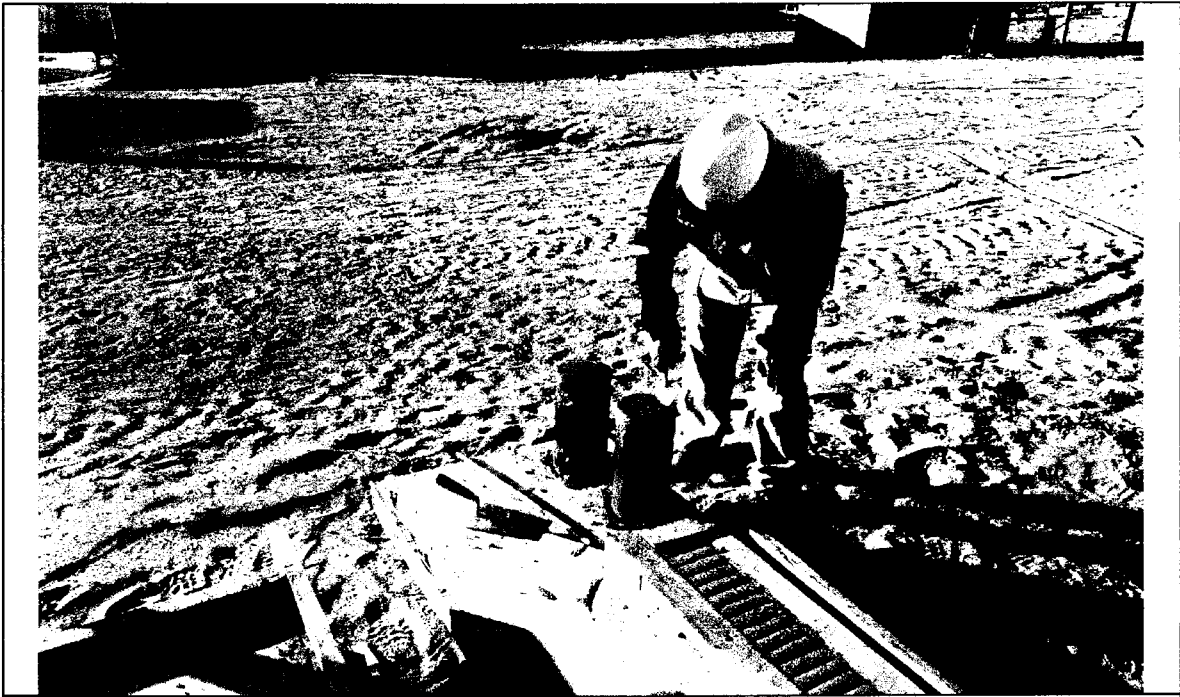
EXTRACCION DE TESTIGOS DE CONCRETO PARA LA PRUEBA DE LA ROTURA A LA COMPRESION.
